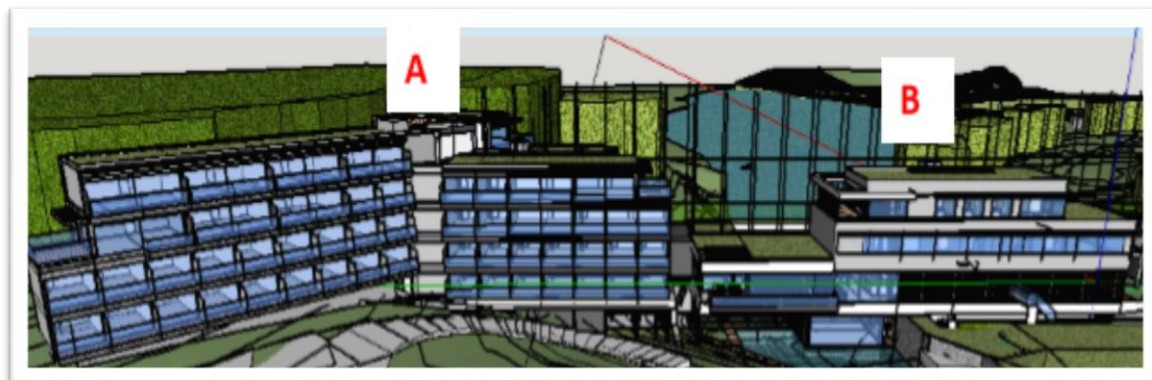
Dessin Sketchup de la façade Ouest de l'hôtel.
